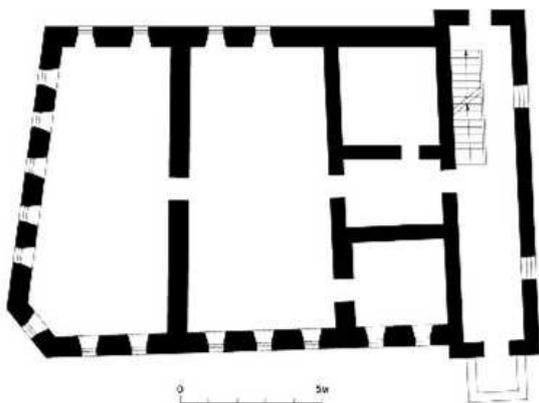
План 1 этажа каменного дома из состава усадьбы Миншутиных [2]
